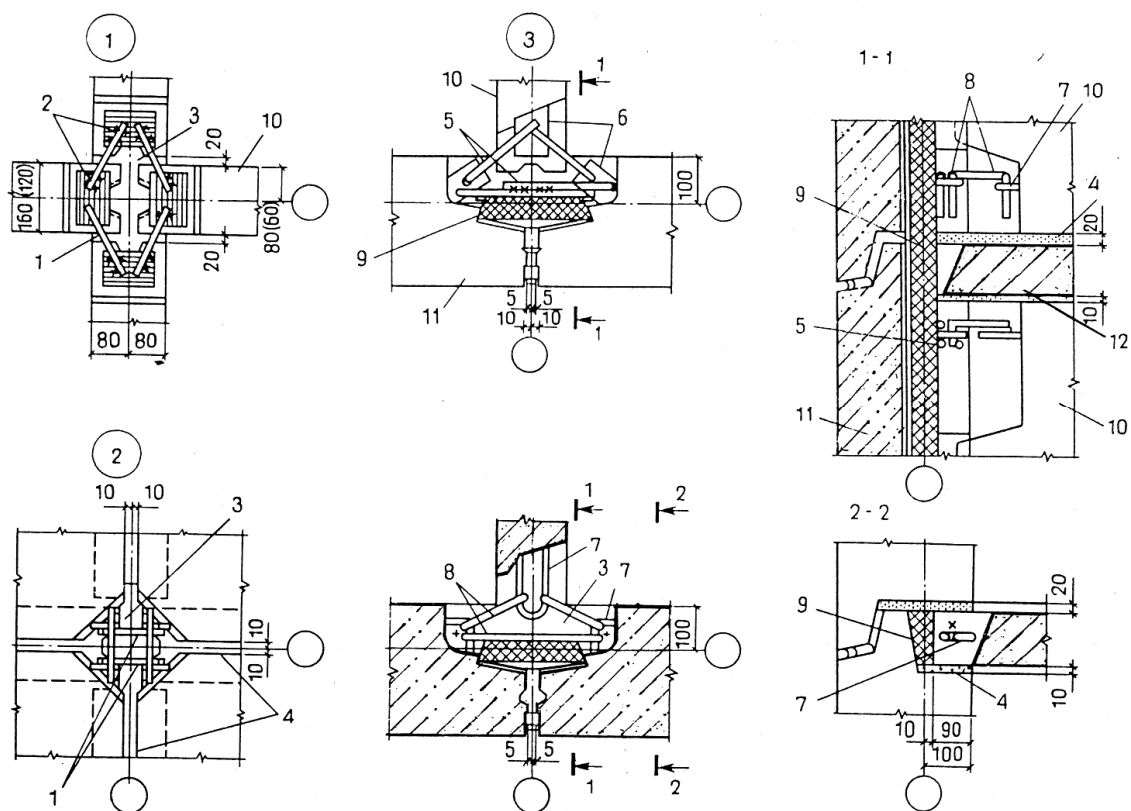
Основные сопряжения конструкций панельного здания: 1 – соединительная накладка; 2 – сварной шов; 3 – бетон; 4 – цементно-песчаный раствор; 5 – стальная полускоба; 6 – стальная пластинка; 7 – петлевой выпуск; 8 – скоба; 9 – утеплитель; 10 – панель внутренней стены; 11 – панель наружной стены; 12 – панель перекрытия
